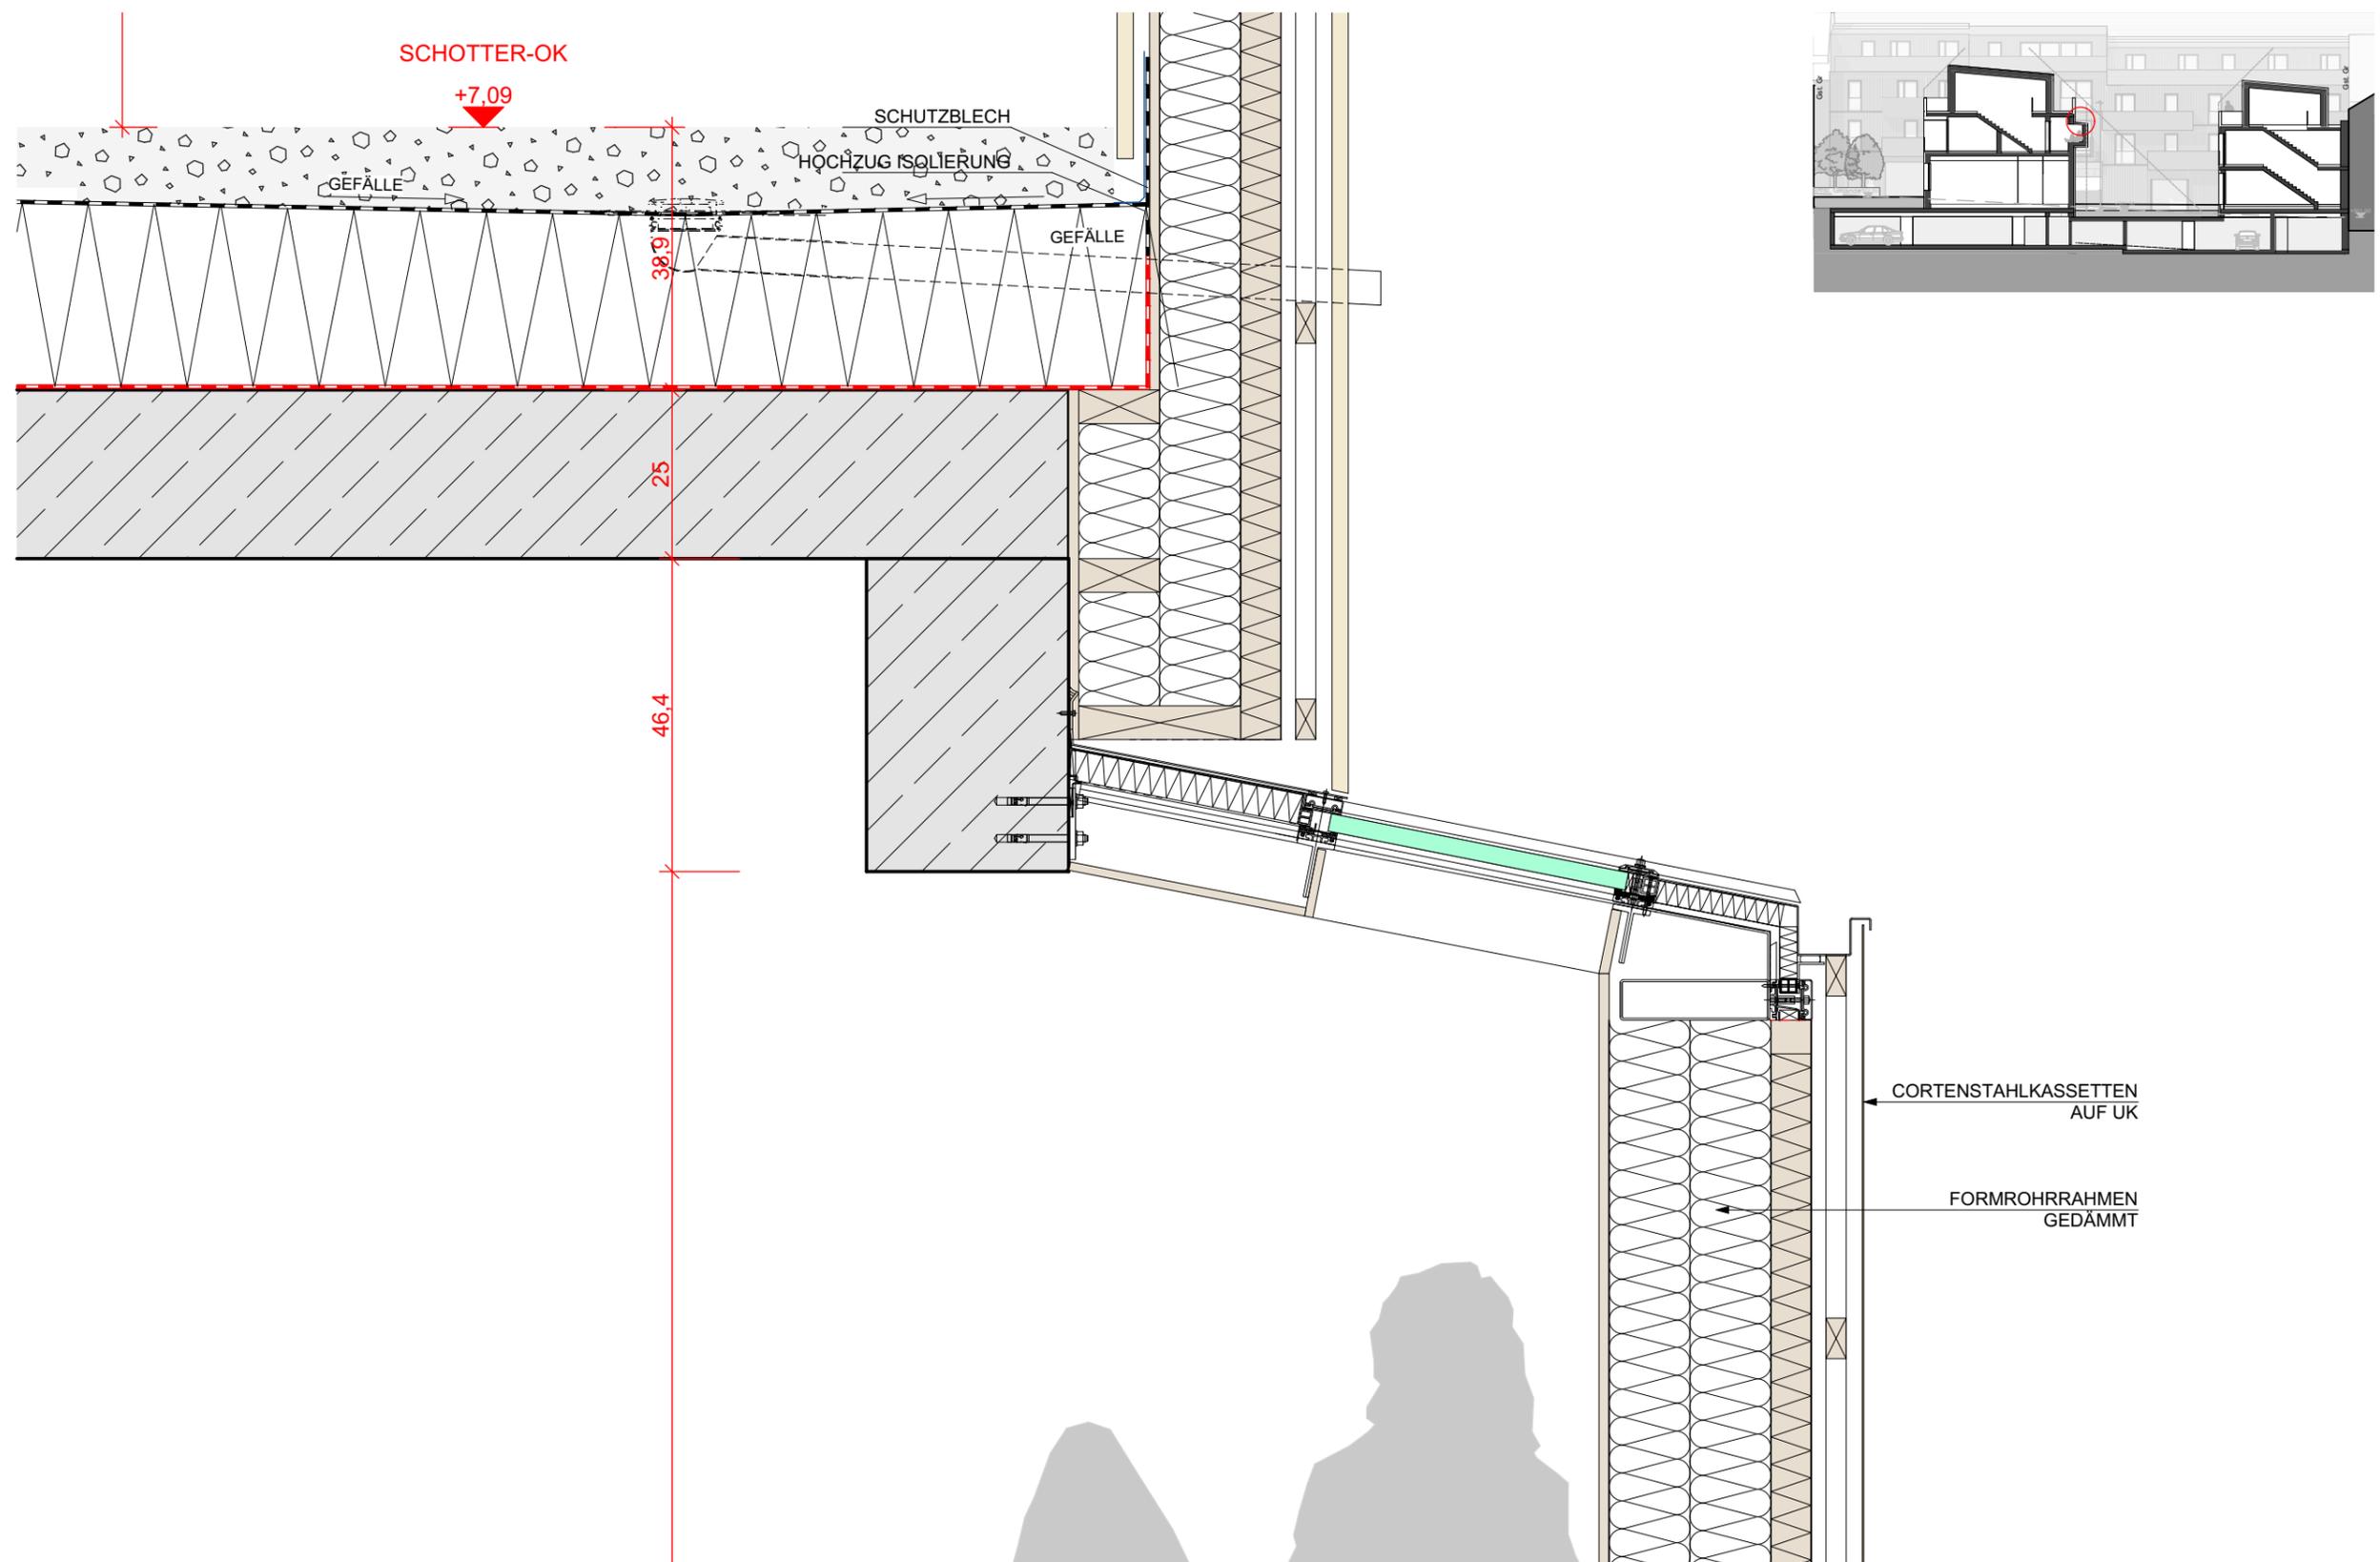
Bauteil 2: Glasdach Sitznische 1:10
